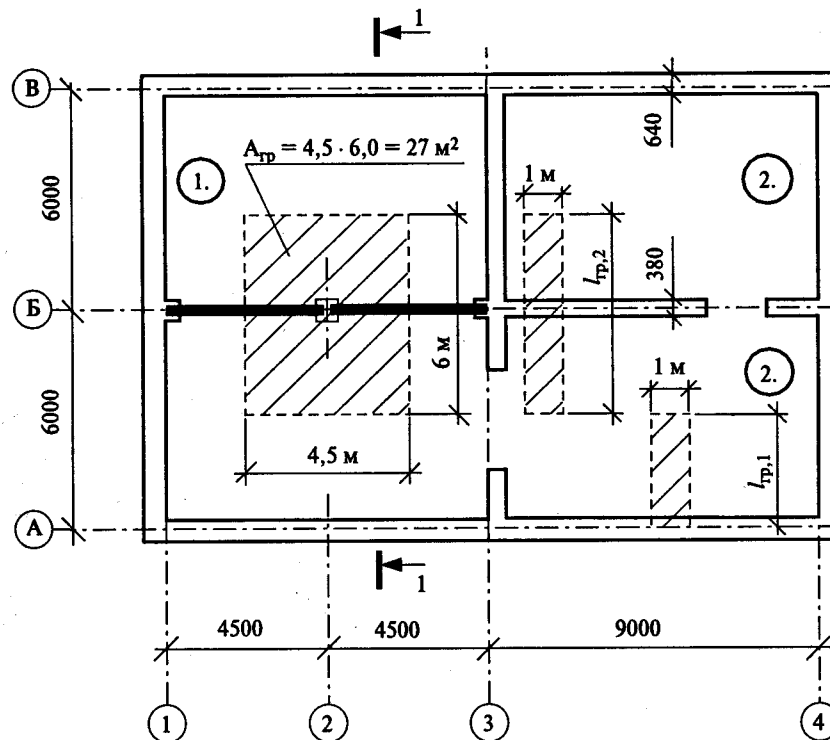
К примеру 3.7. План первого и второго этажей здания:
